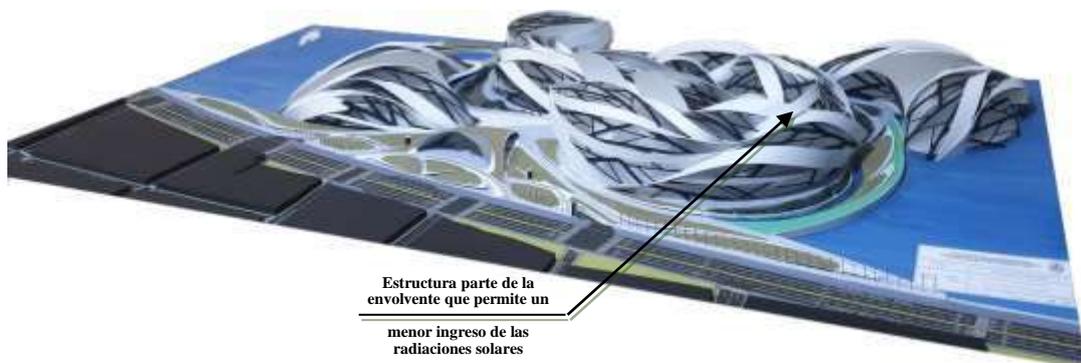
Fachada norte del proyecto arquitectónico.
